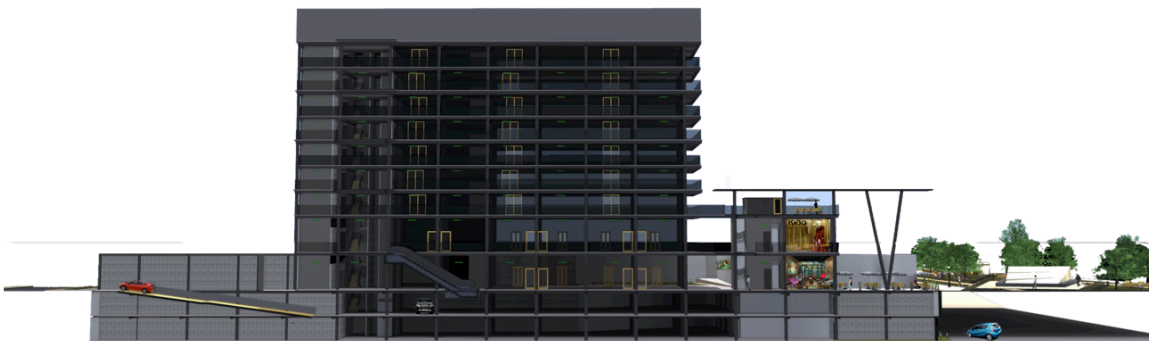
18 VISTA 4 Corte de sección con vista hacia edificio 2.
